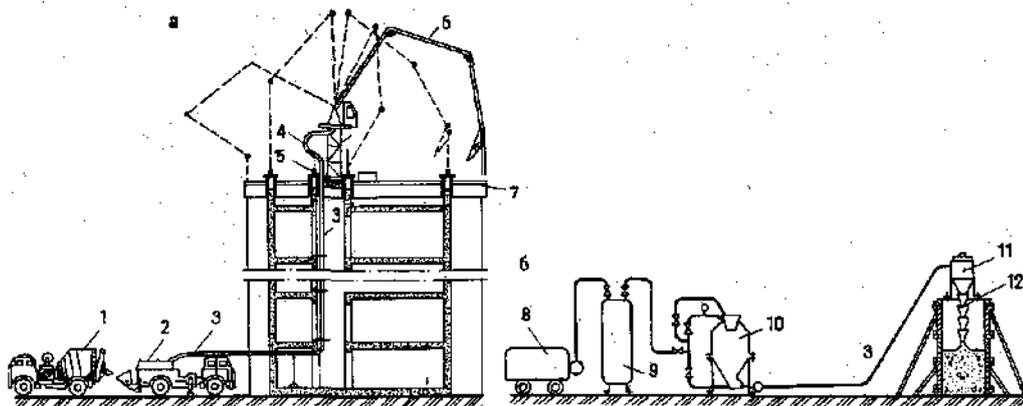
Схема подачи бетонной смеси с помощью автобетононасоса (а) и пневматического нагнетателя (б) : 1 — автобетоносмеситель; 2 — автобетононасос; 3 — бетоновод; 4 — рукав (компенсатор длины бетоновода); 5 — постамент с полноповоротной платформой; 6 — распределительная стрела; 7 — скользящая опалубка; 8 — компрессор; 9 — ресивер; 10 — пневмонагнетатель; 11 — гаситель; 12 — хобот; (пунктиром даны положения стрелы).
